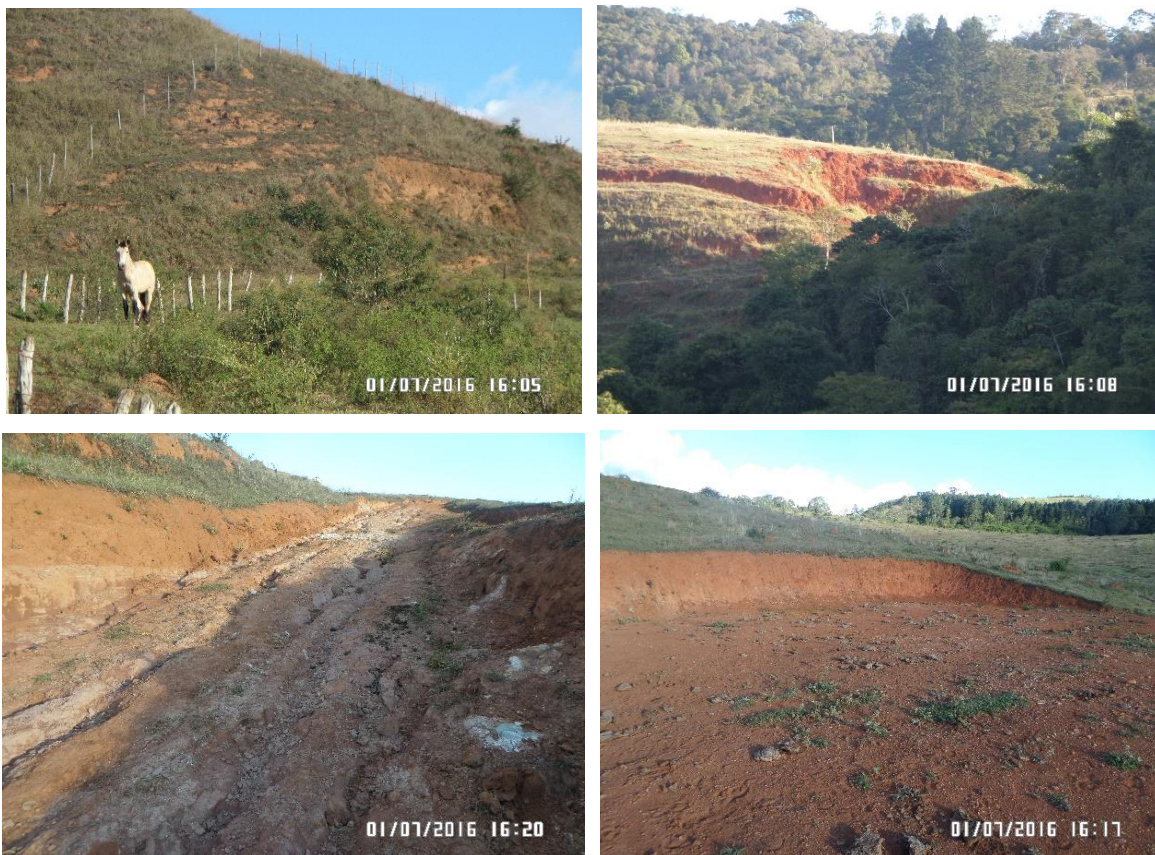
Trechos de estradas vicinais em mau estado de conservação
